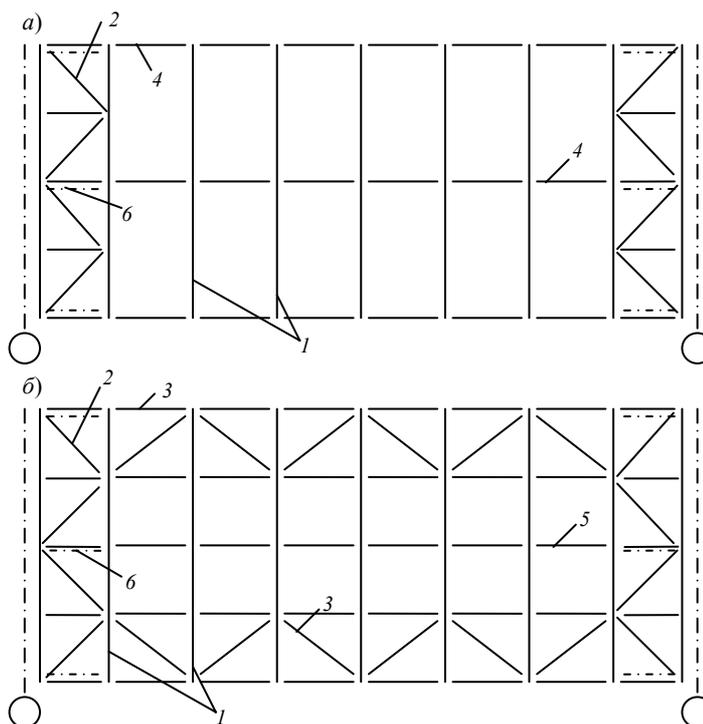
Схема связей по верхним (а) и нижним (б) поясам ферм:
